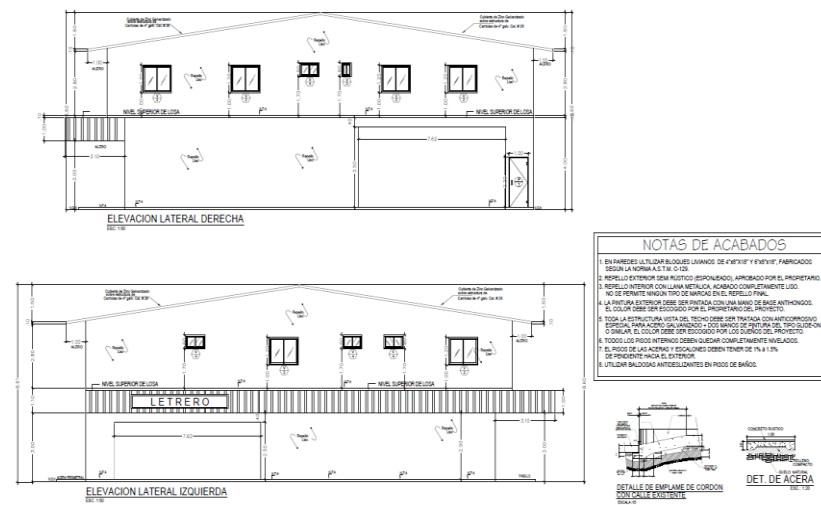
Fachadas proyecto elevación lateral izquierda
